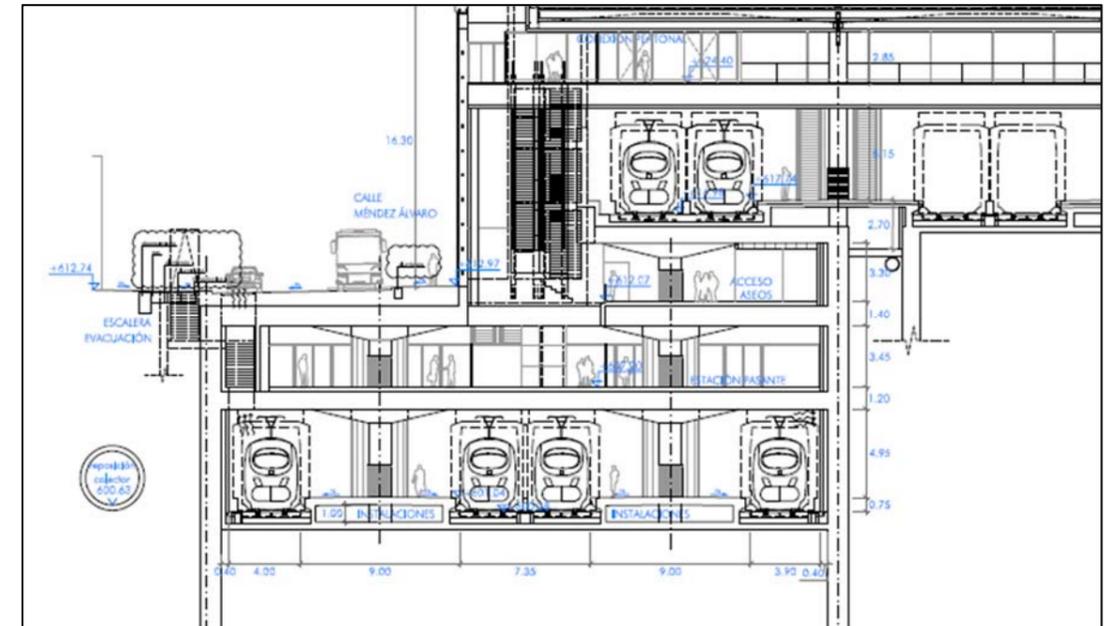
Estación Pasante. Sección por zona sur de losa nivel 607
